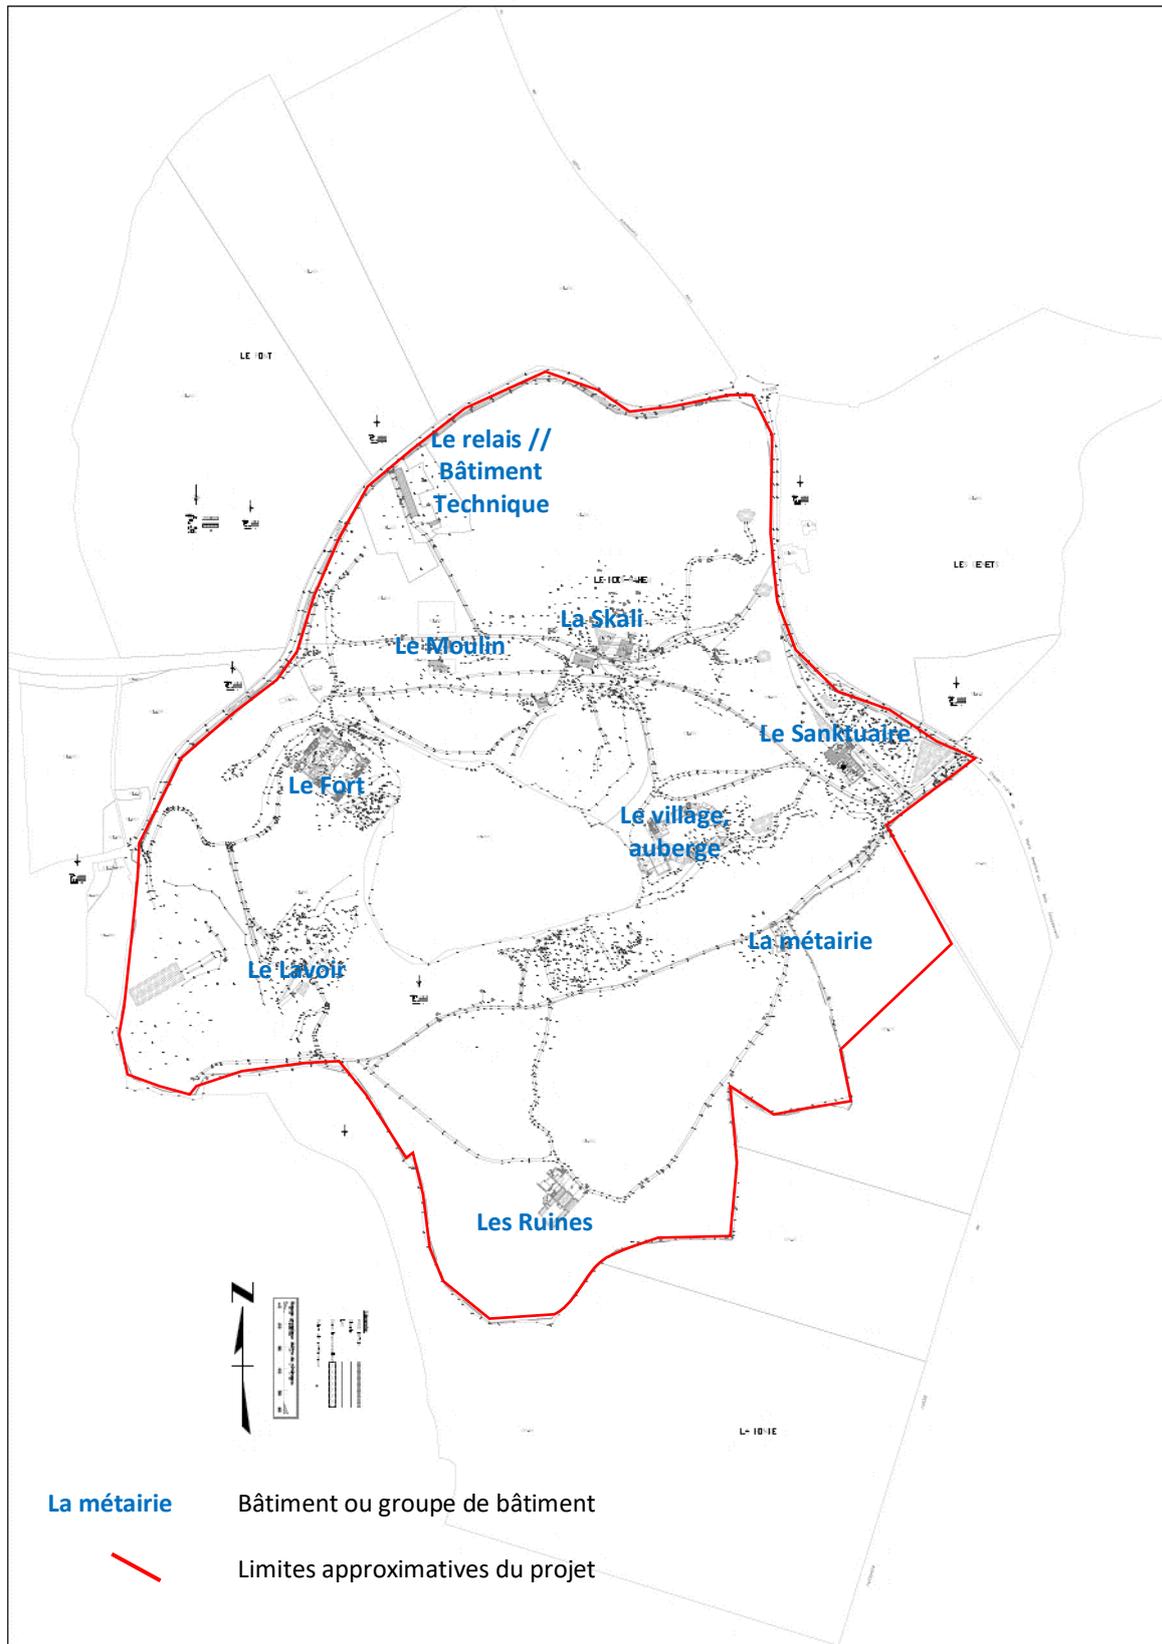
Plan schématique permettant de localiser les différents espaces du parc d'immersion
